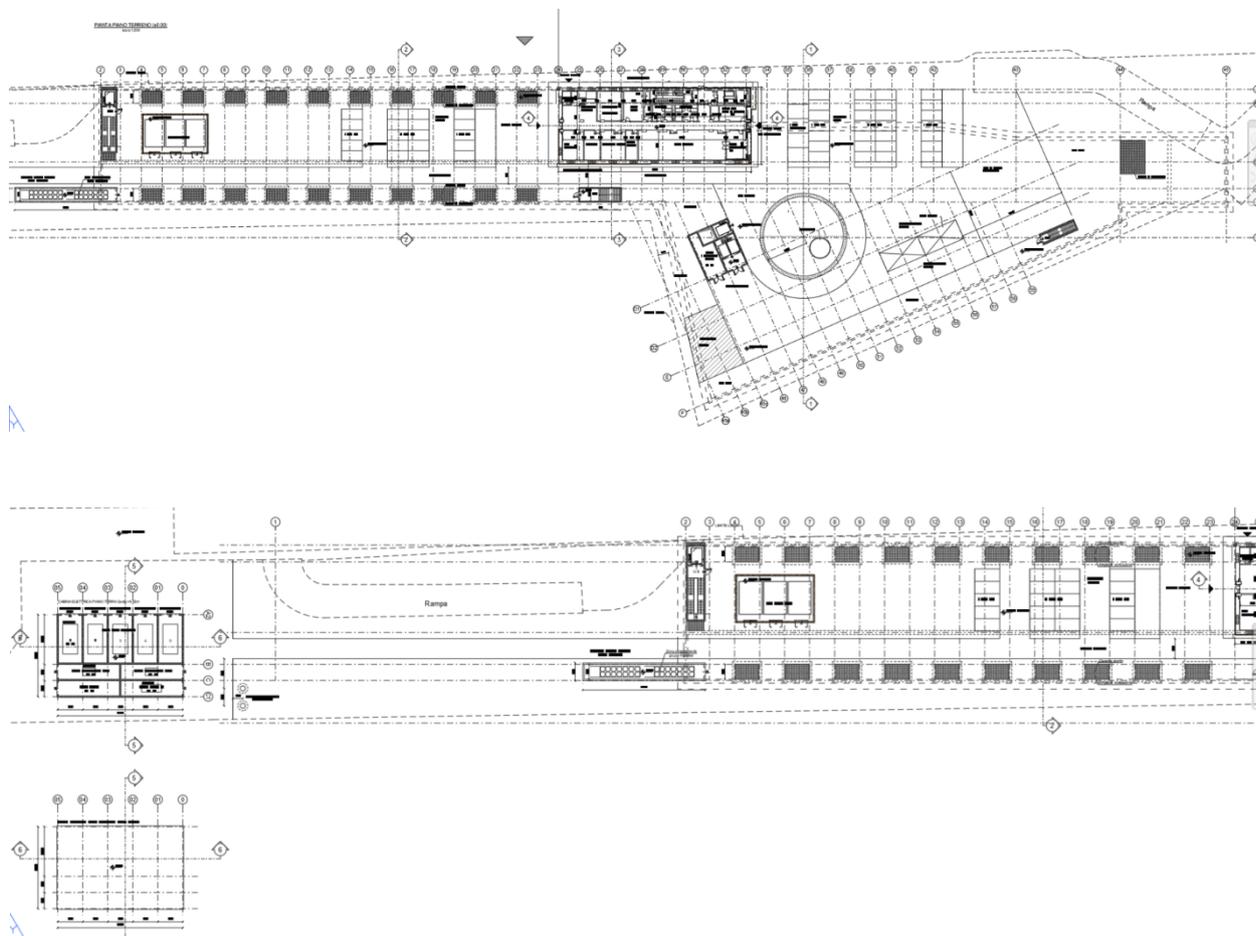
Inquadramento planimetrico dell'opera: Pianta Livello 0
